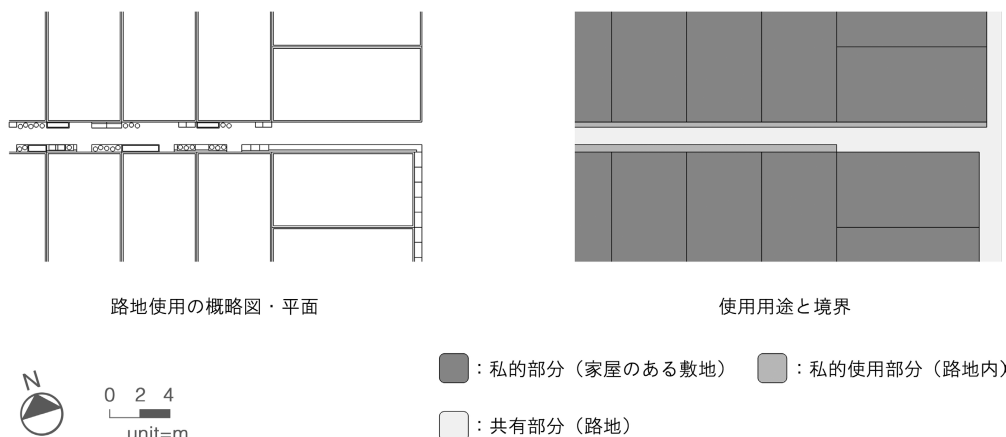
70 rai 地区内路地の概略図と空間使用・平面
